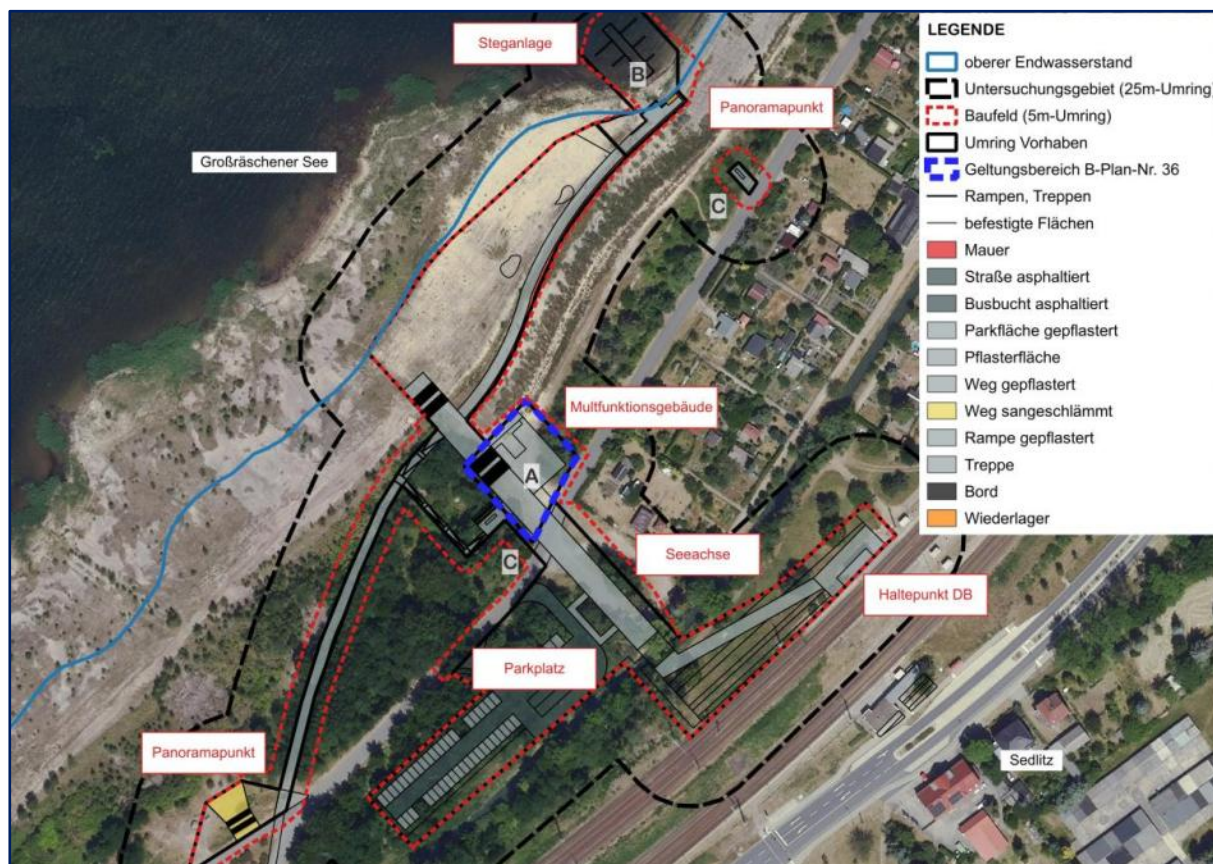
Grundriss technische Planung (Quelle: 360° LA)
